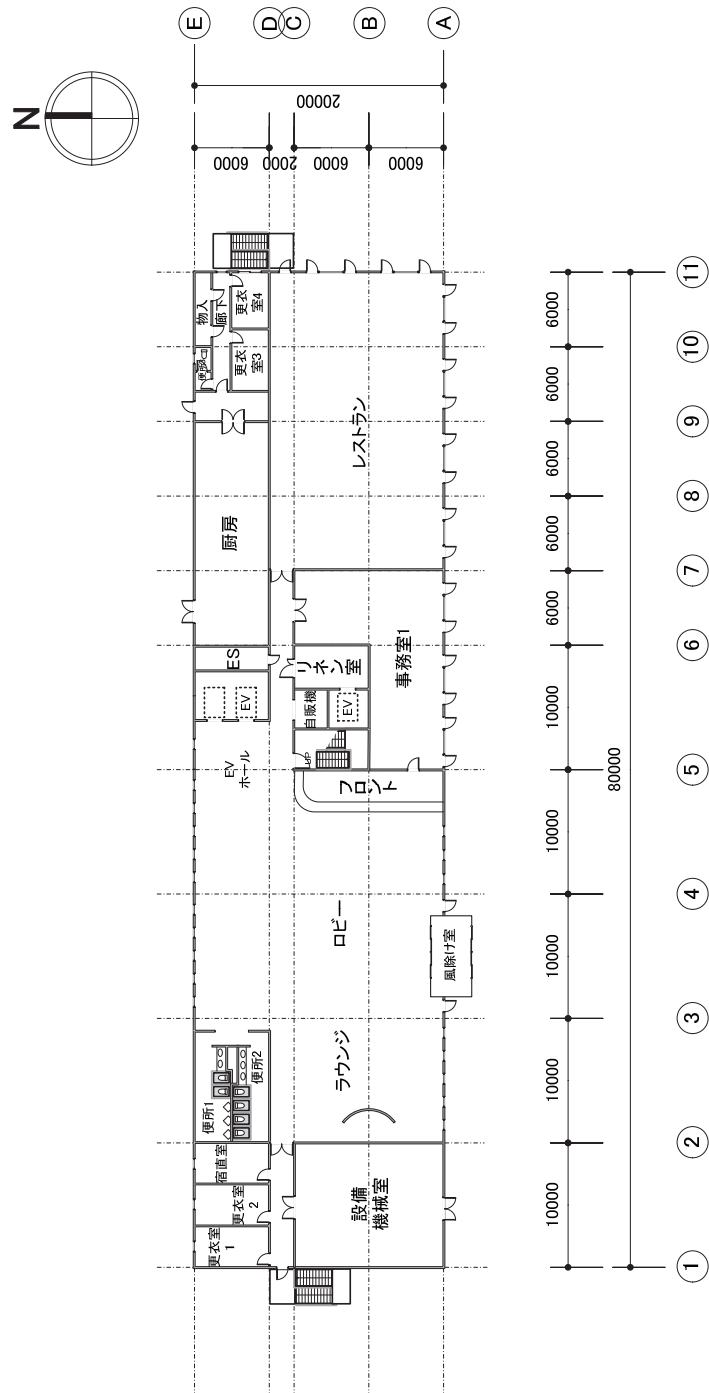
モデル建物 (ホテル等、5,000m²) 1 階平面図
